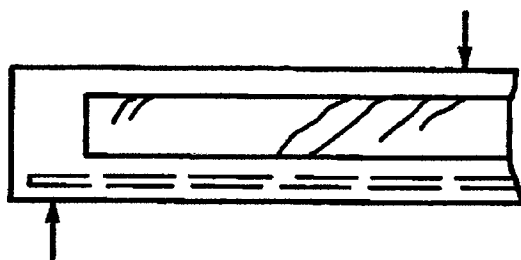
Fisuras de cortante en el alma en una viga doble T.
